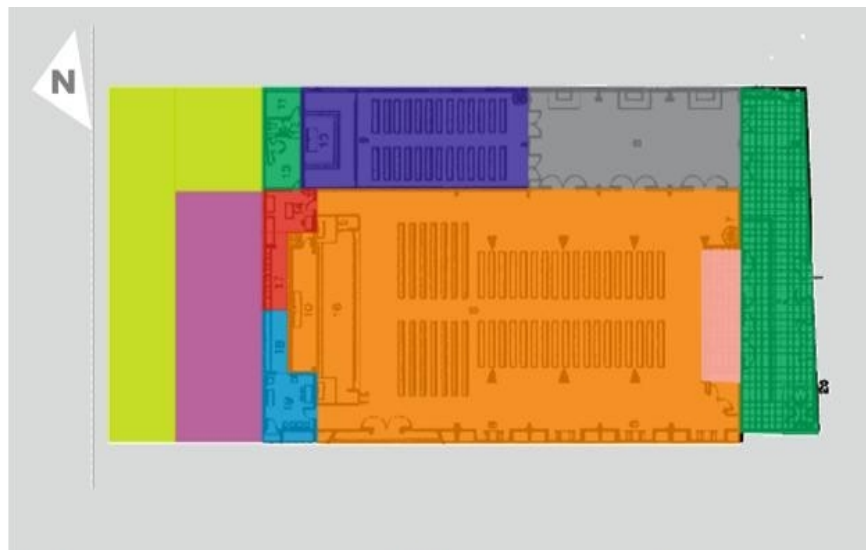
LOCALIZACIÓN DE LA PARROQUIA DE LA MEDALLA MILAGROSA
